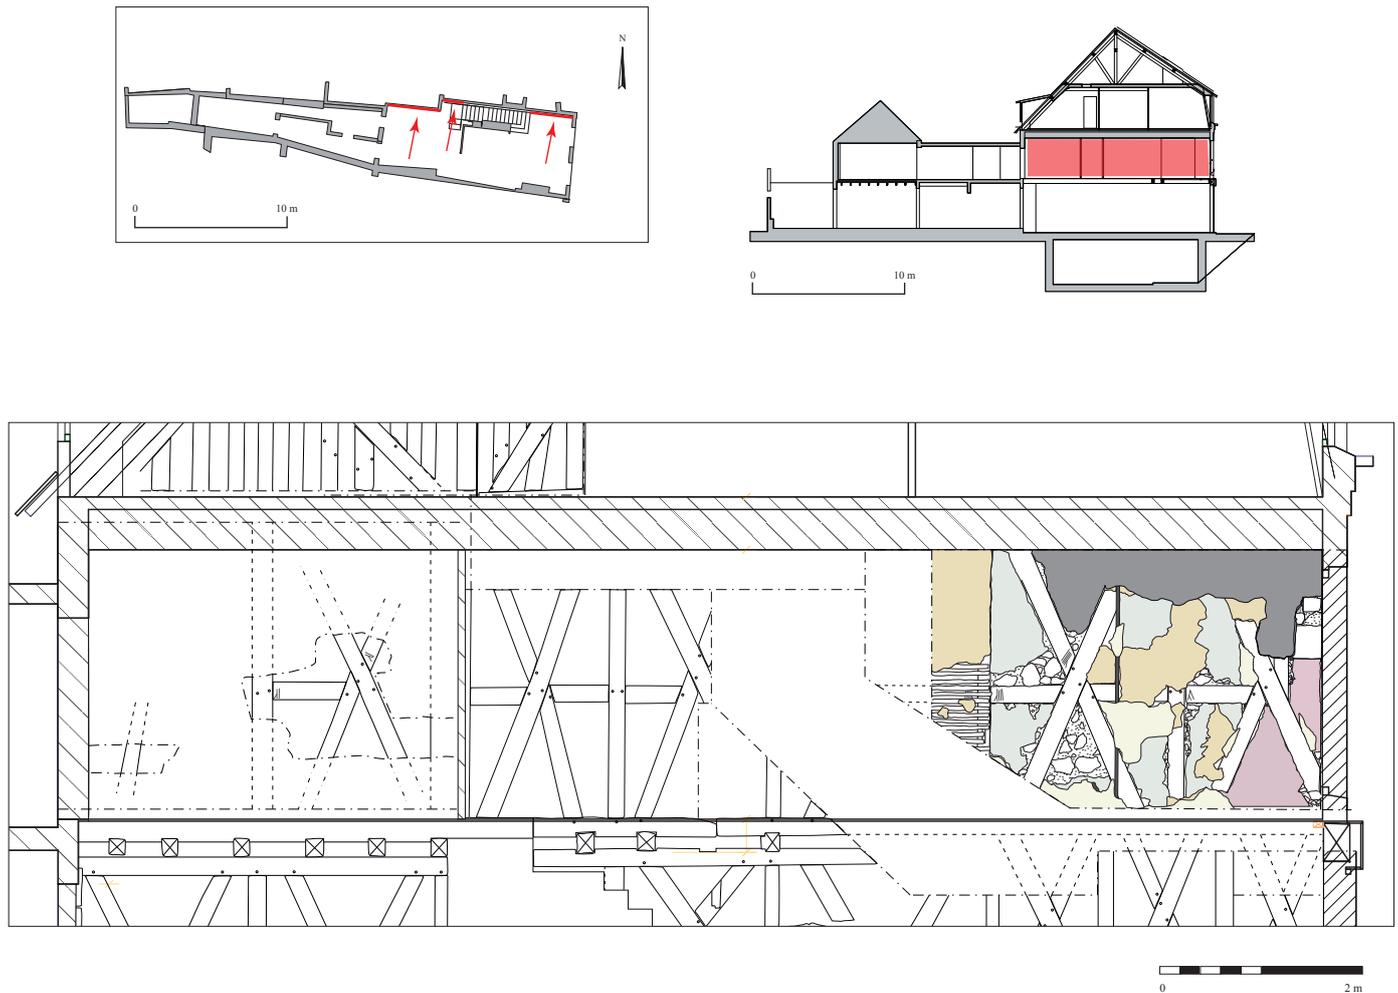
Élévation du mur nord au niveau du premier étage (relevé S. Bryant, Inrap et A. Prévot, Inrap).
